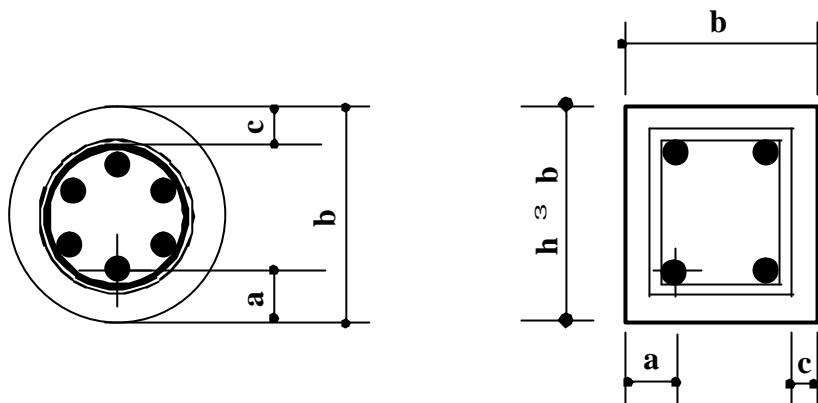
Seções transversais de peças usuais de concreto armado
